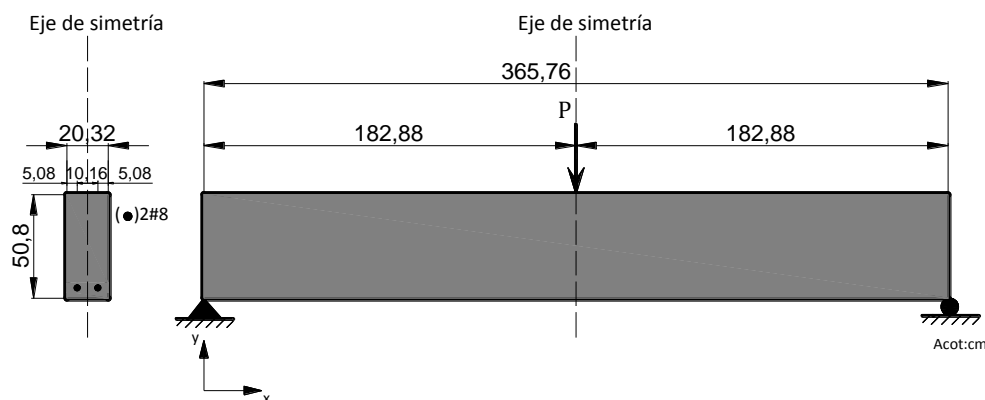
Geometría y refuerzo de viga simplemente apoyada
